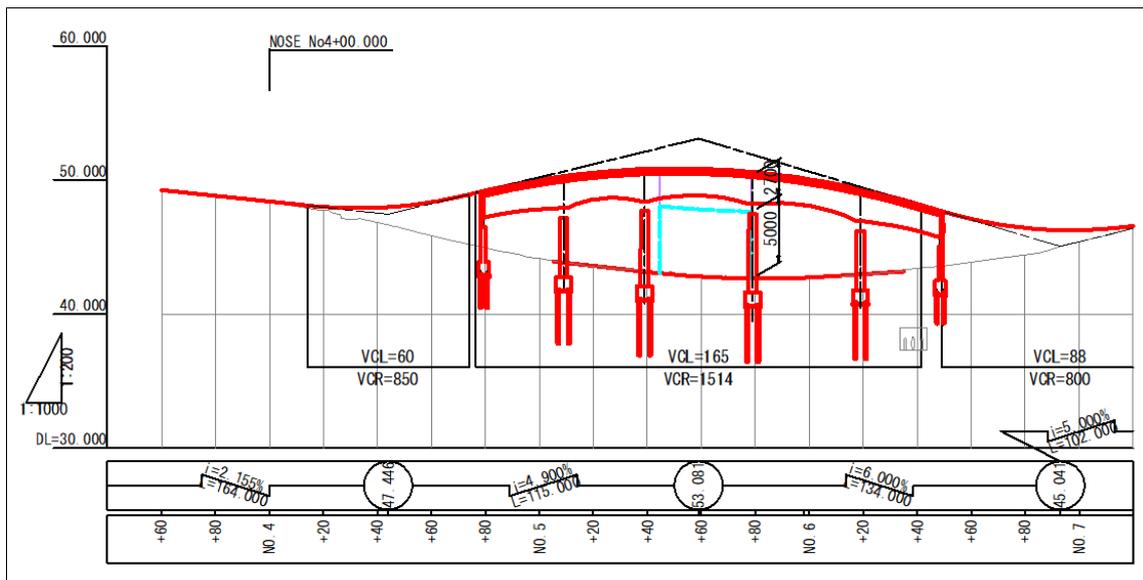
Plan d'implantation du carrefour de l'École de police (2)
